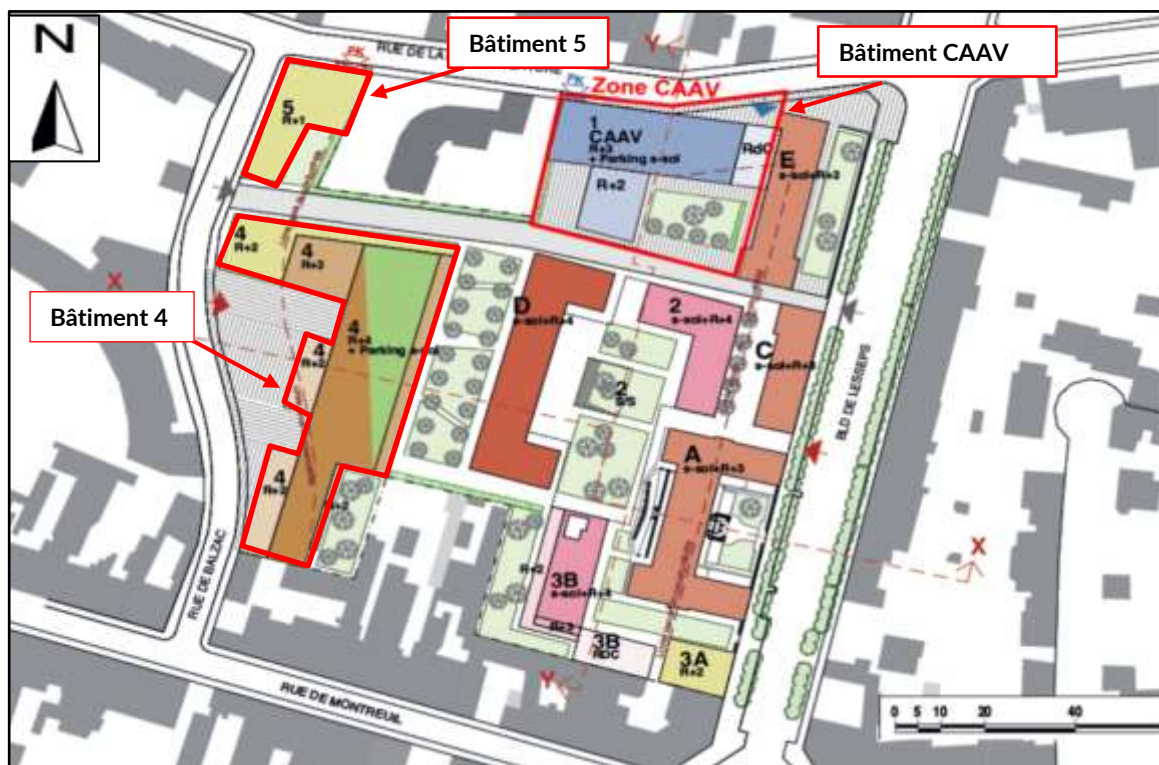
Extrait du plan de masse du projet (source : La Soderec)
